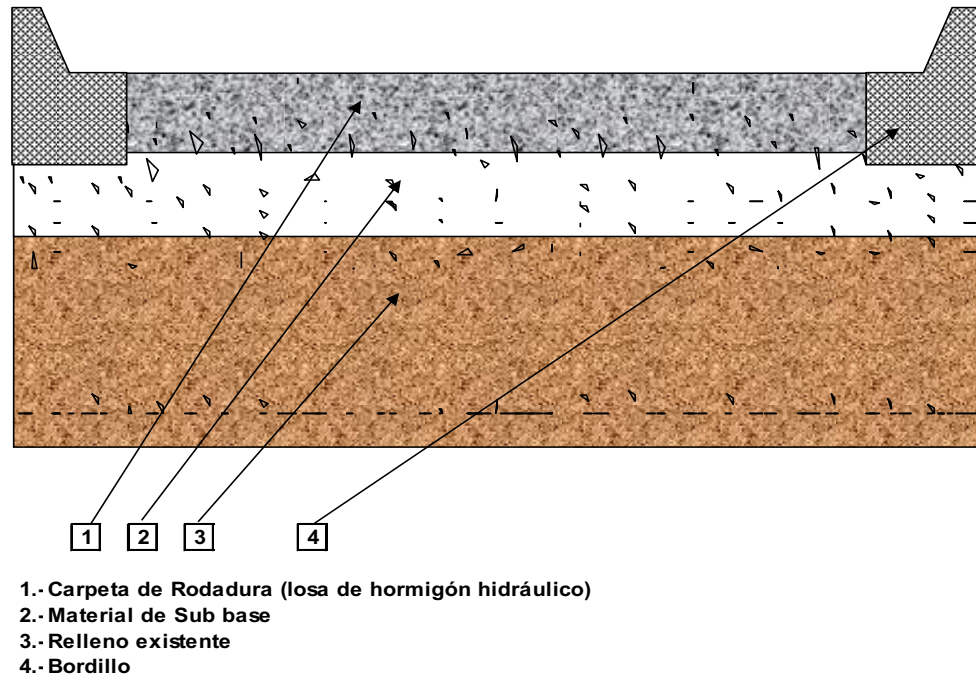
Sección Típica del Pavimento Rígido/Fuente Propia
